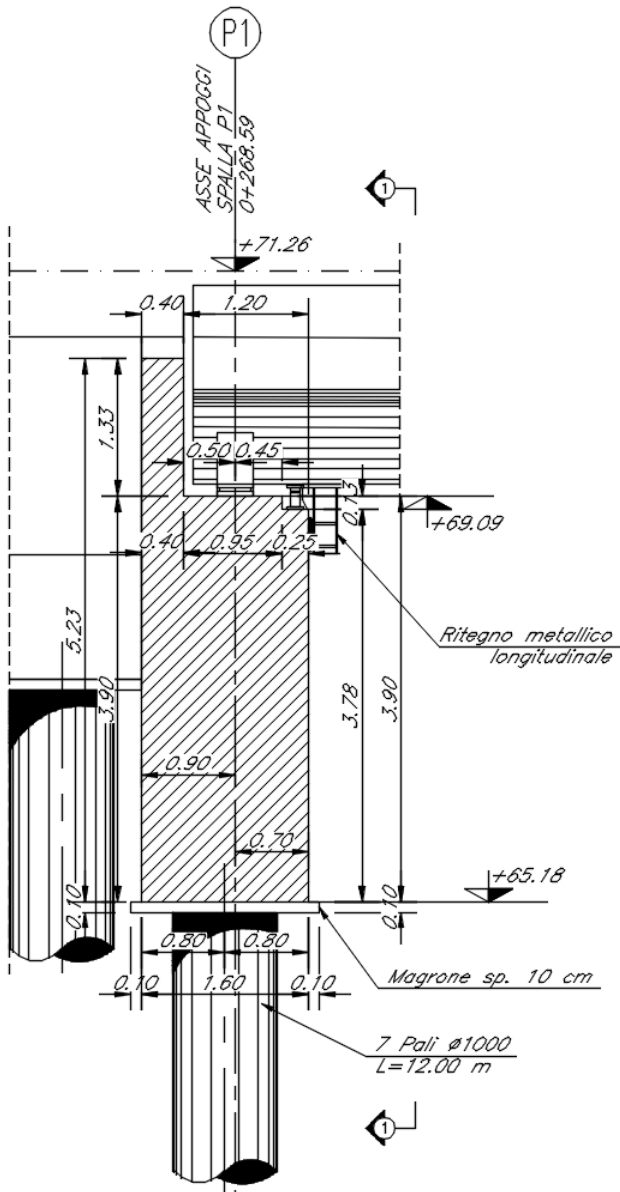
Spalla P1 - Sezione longitudinale 4-4 (sezione longitudinale altezza minore)
